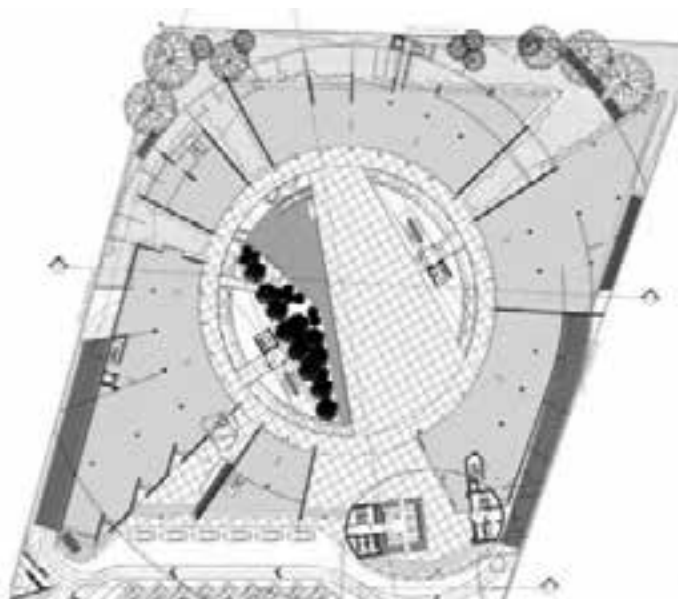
Planta baja comercio de hotel habita en Monterrey. Foto int
